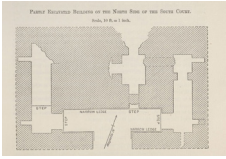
Plano de edificio parcialmente excavado MAUDSLAY 1899.:lámina 6
